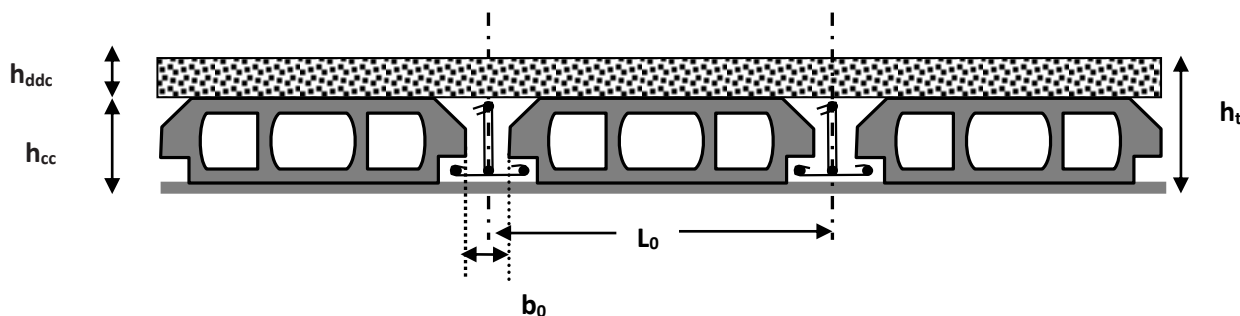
Coupe transversale sur un plancher à corps creux
